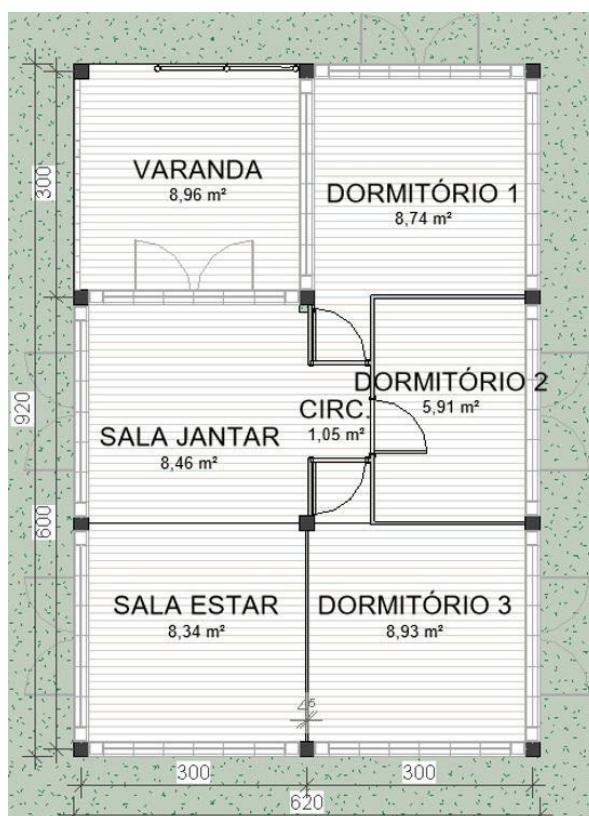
Planta baixa do abrigo. Fonte: elaborado pelas autoras (2025).
